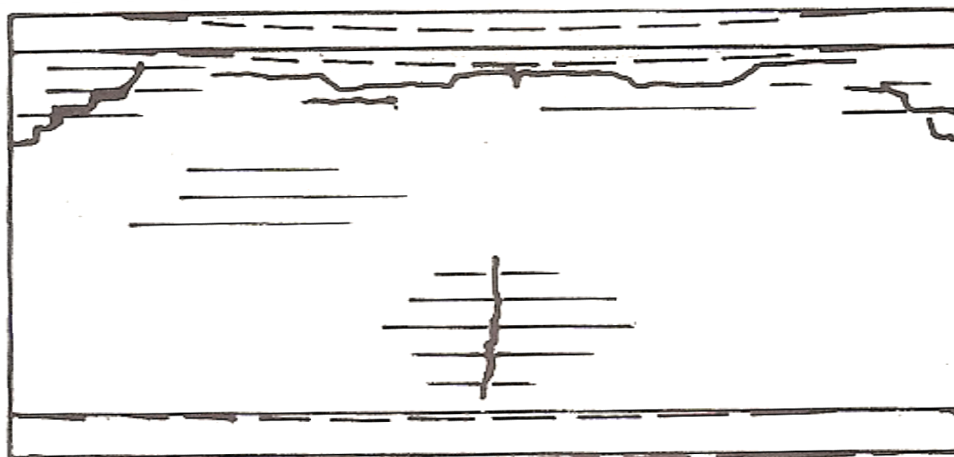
TRINCAS EM PAREDE DE VEDAÇÃO: DEFORMAÇÃO DO SUPORTE INFERIOR À DEFORMAÇÃO DA VIGA SUPERIOR
